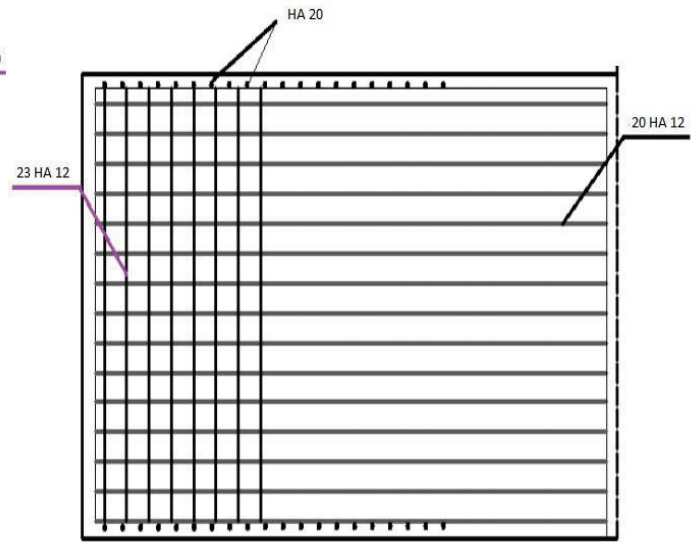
Ferrailage de la semelle (nappe supérieure)
